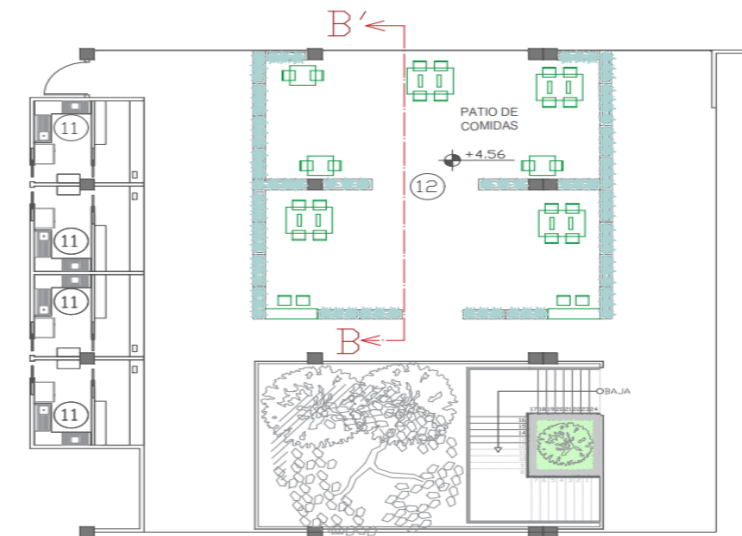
propuesta de zonificación y distribución de locales de indumentaria plano planta baja
